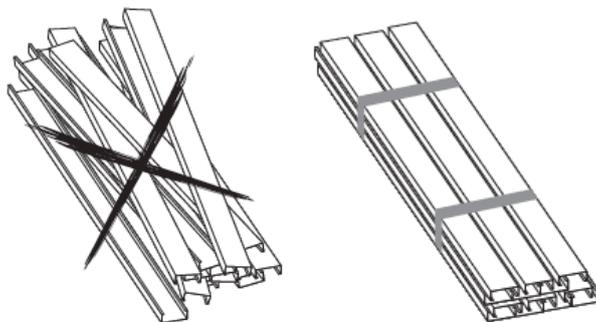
Recomendações para armazenamento de perfilados de aço (imagens cedidas pela Associação Brasileira do Drywall)
